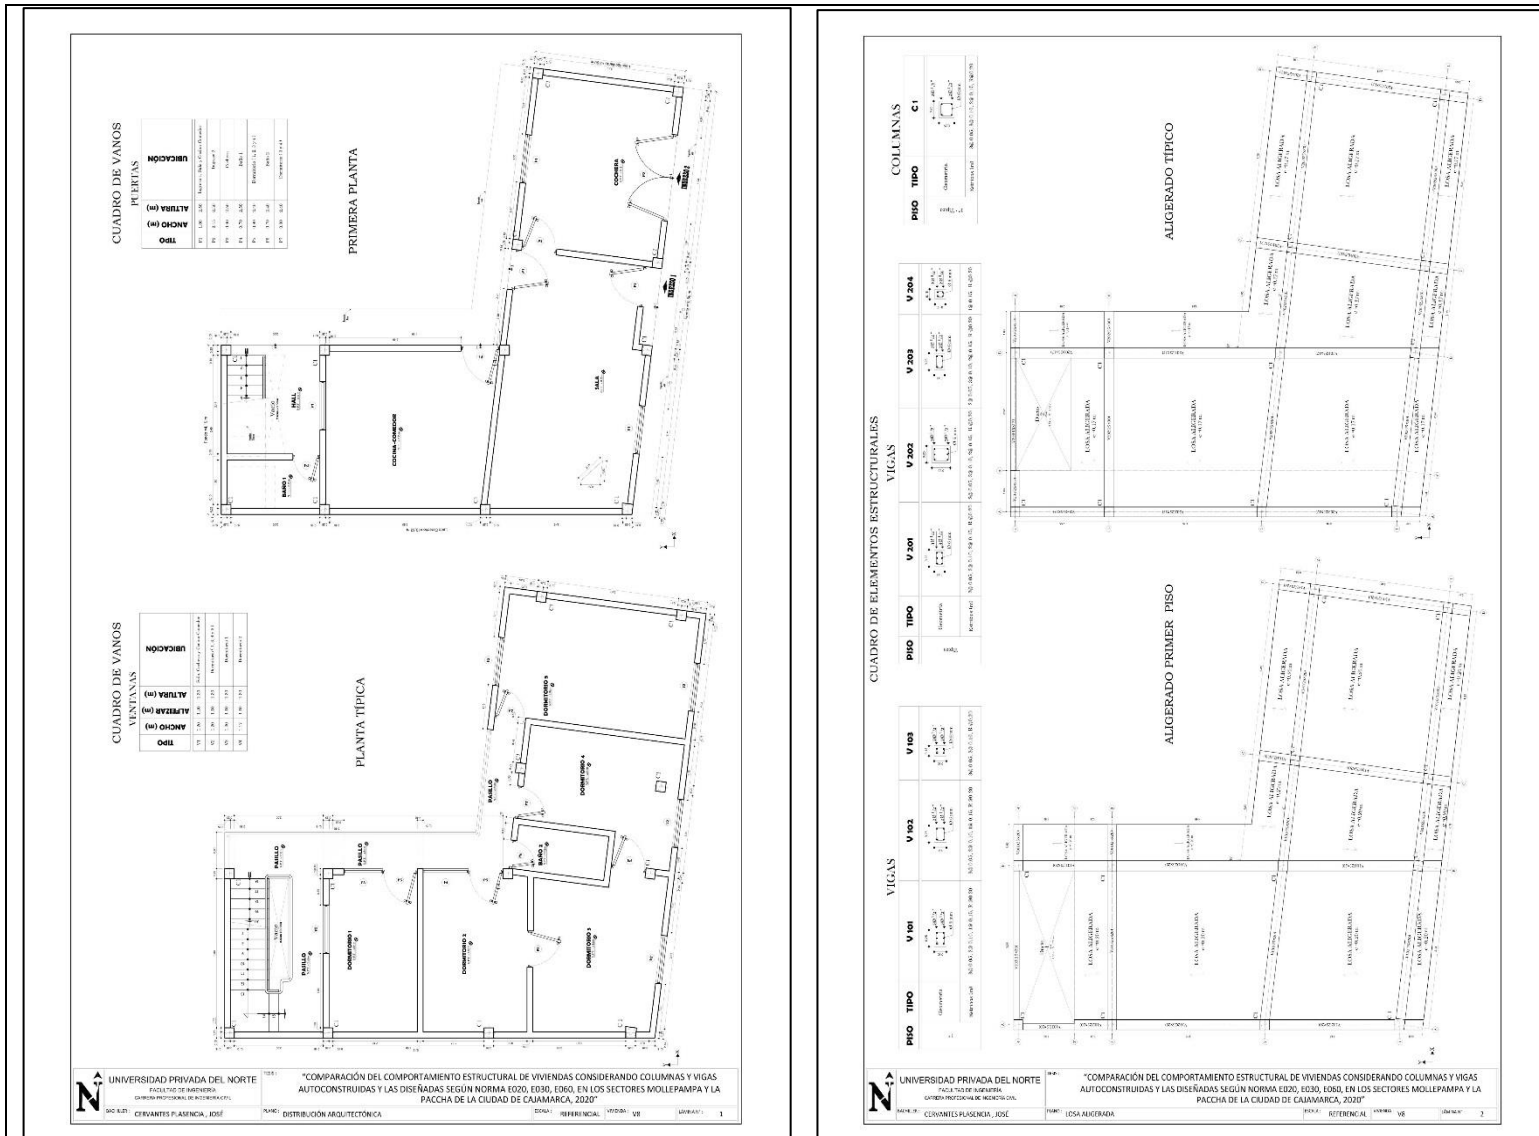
Planos de arquitectura y losa aligerada vivienda 8
